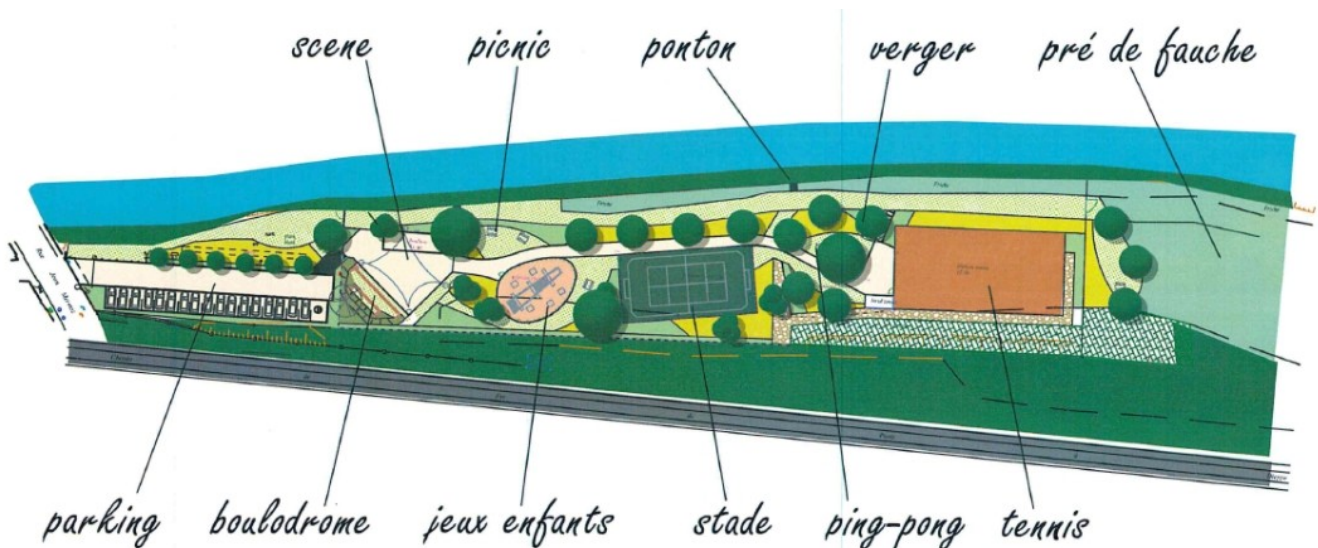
Plan du projet de parc sportif (source : document "Présentation projet", p. 7)
